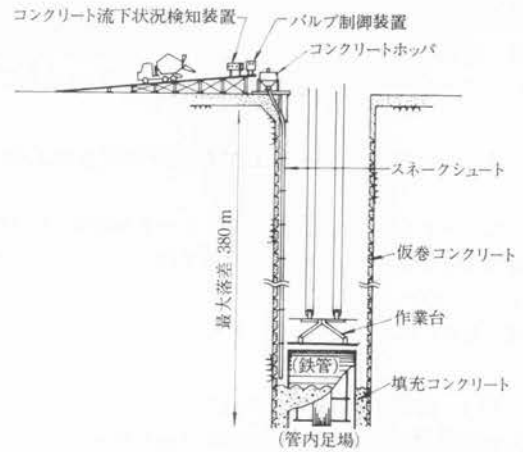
No. 4 地下発電所垂直鉄管路填充コンクリート
